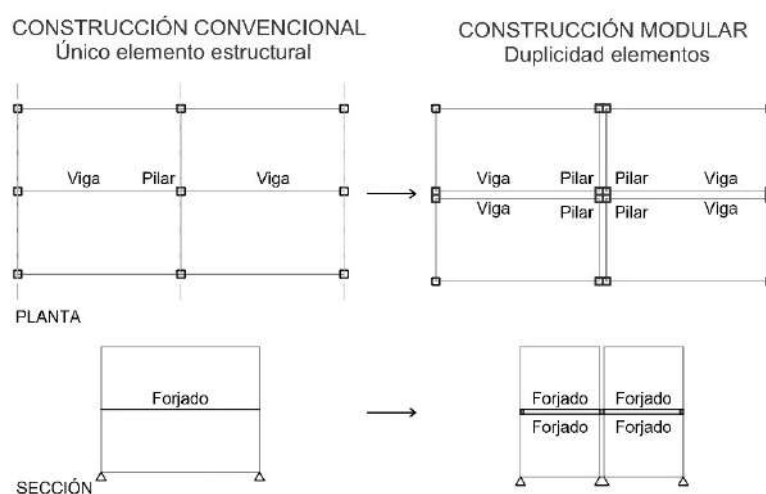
Esquema comparativo entre la construcción convencional y la construcción modular donde se aprecia la duplicidad de elementos. Fuente: Elaboración propia.
